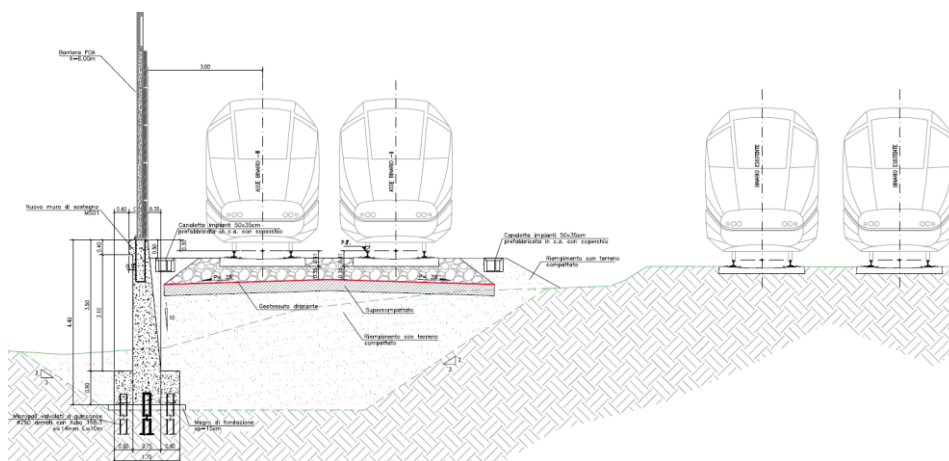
Sezione tratto a sud del nuovo ponte ferroviario sulla linea RFI con ricollocazione delle barriere fonoassorbenti già presenti (sezione muro MS01)
